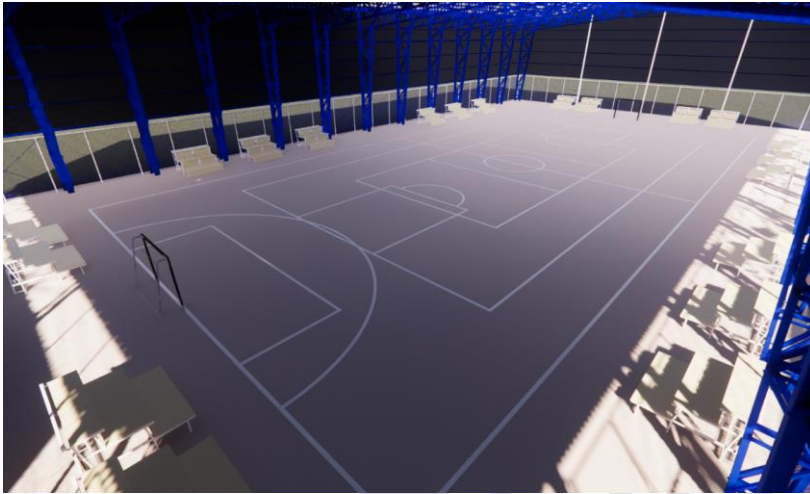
Vista interna espacio deportivo techado. Fuente: Elaboración propia.
